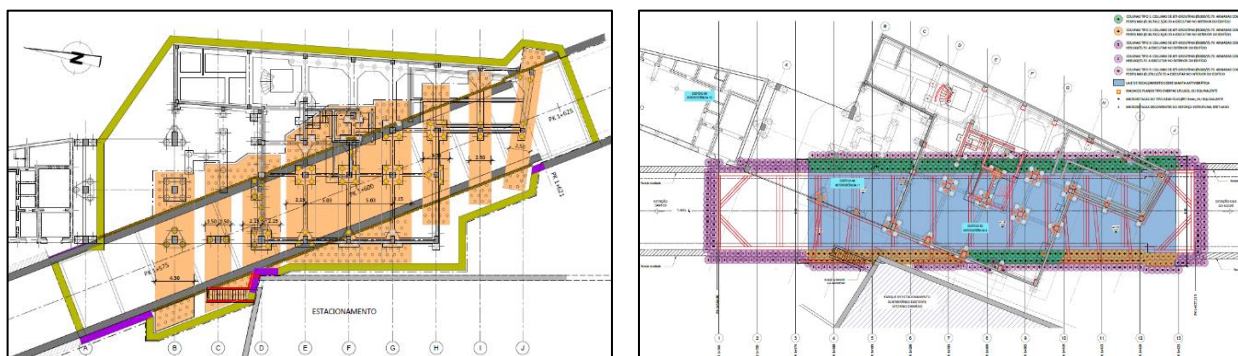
Planta da Intervenção da Obra Especial do Programa Preliminar no Projeto de Execução
